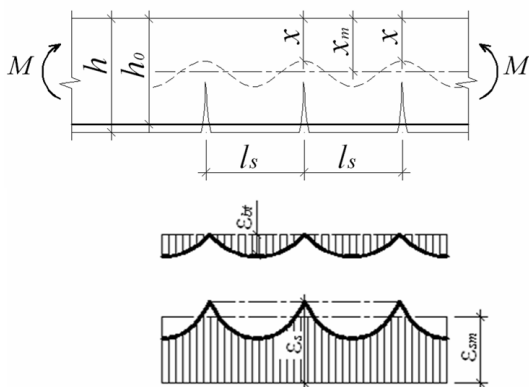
Распределение деформаций в растянутом бетоне и в растянутой арматуре по длине элемента с трещинами
